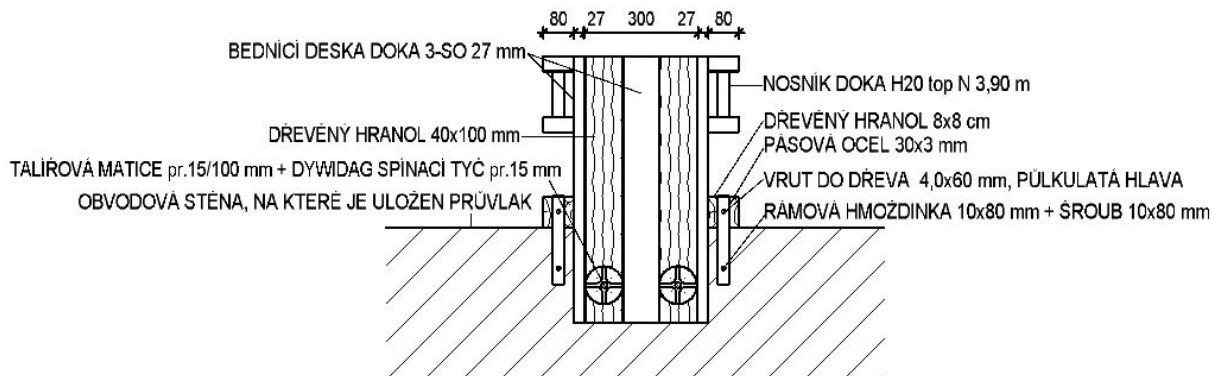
DETAIL BEDNĚNÍ PRŮVLAKU 300x300 mm
